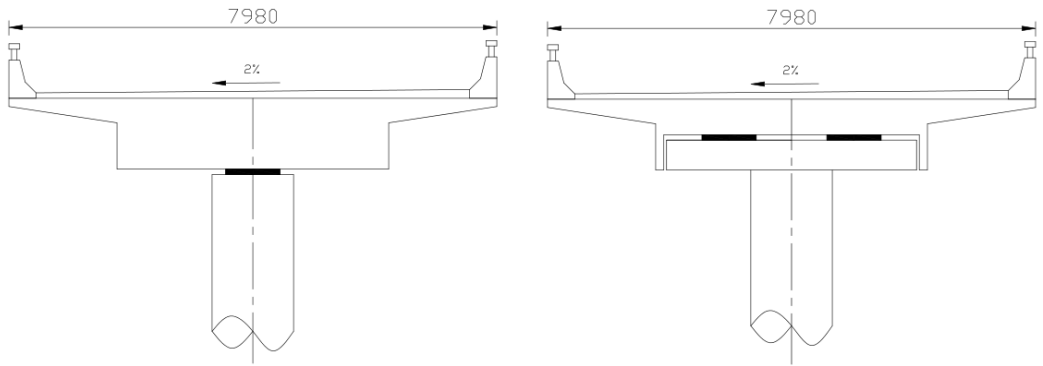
琵琶王立交桥 A 匝道桥-梁端截面图（单位：mm）
